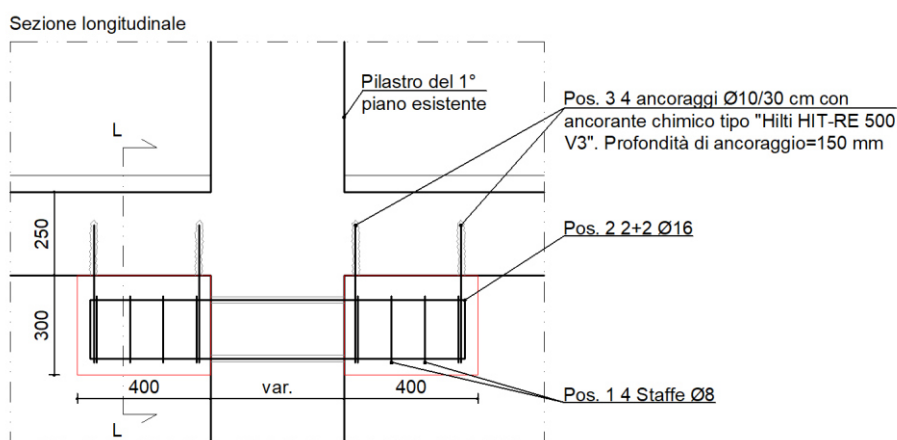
Dettaglio del rinforzo delle travi del primo solaio.
